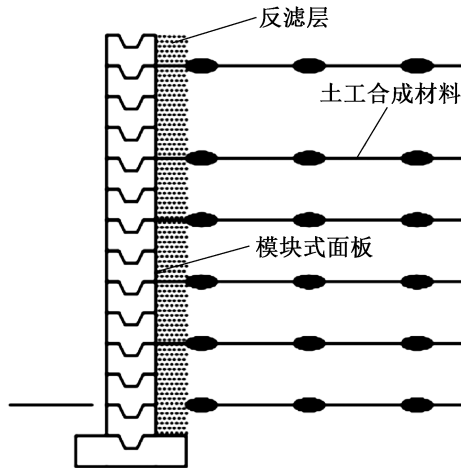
预制混凝土模块式墙面结构形式示意图
